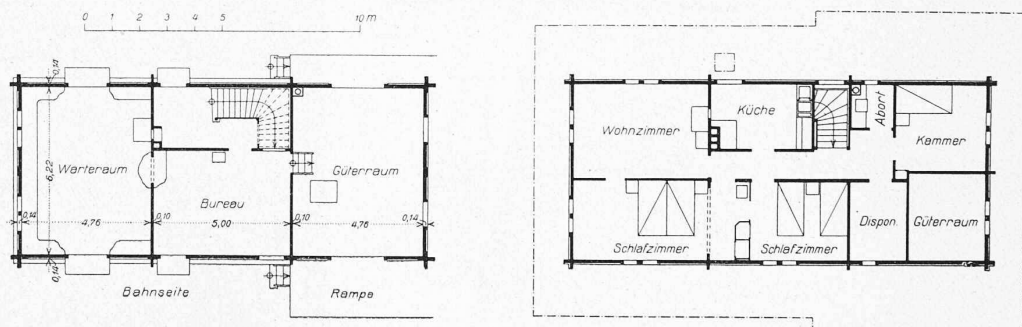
und 5. Typus der Zwischenstationen Ilanz-Disentis. — Grundrisse 1 : 250.
